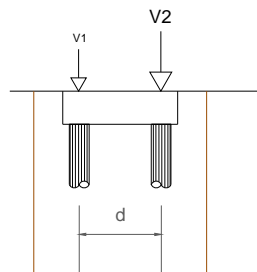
Cargas iniciales grupo de dos pilotes y cargas descompuestas para cálculo.
